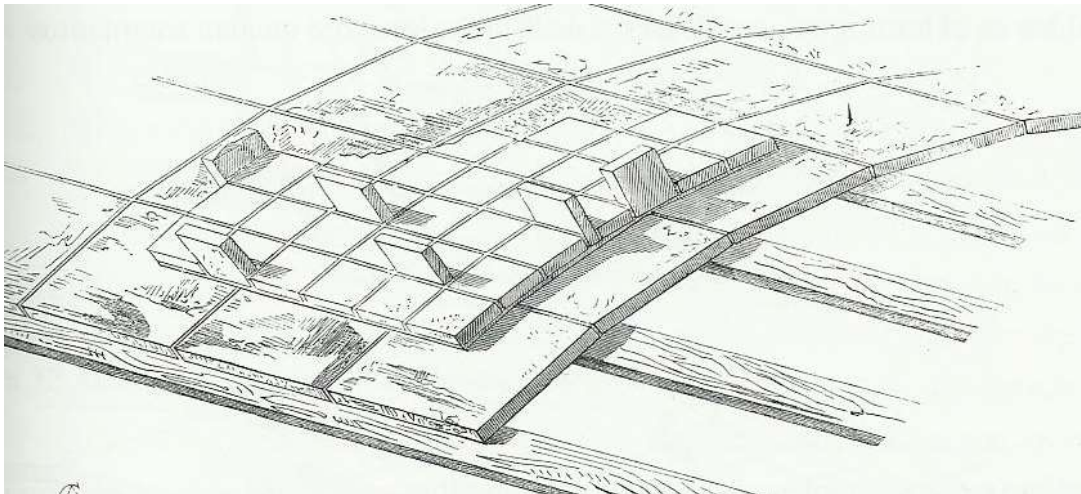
Detalle de armadura tabicada (Imagen 30 en Choisy (1999:55))
